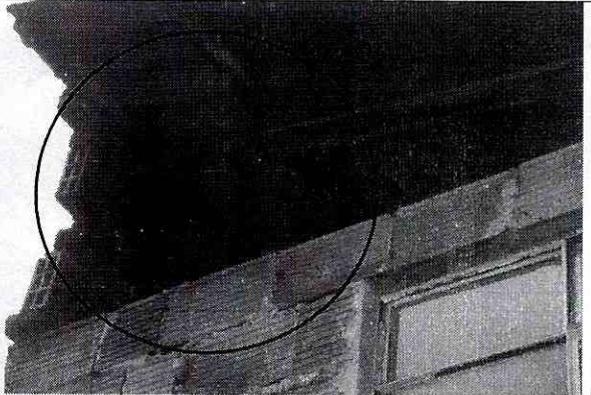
Apoyo inadecuado de la cubierta de la zona posterior
